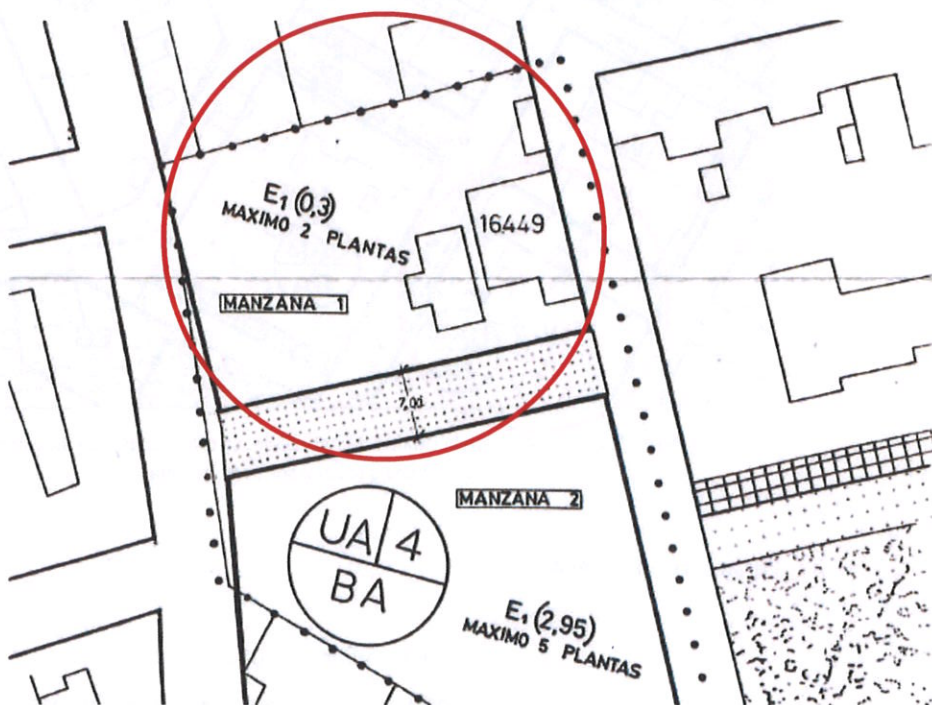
Plano de la modificación nº 107 con la nueva disposición de la calle y normativa a aplicar.
